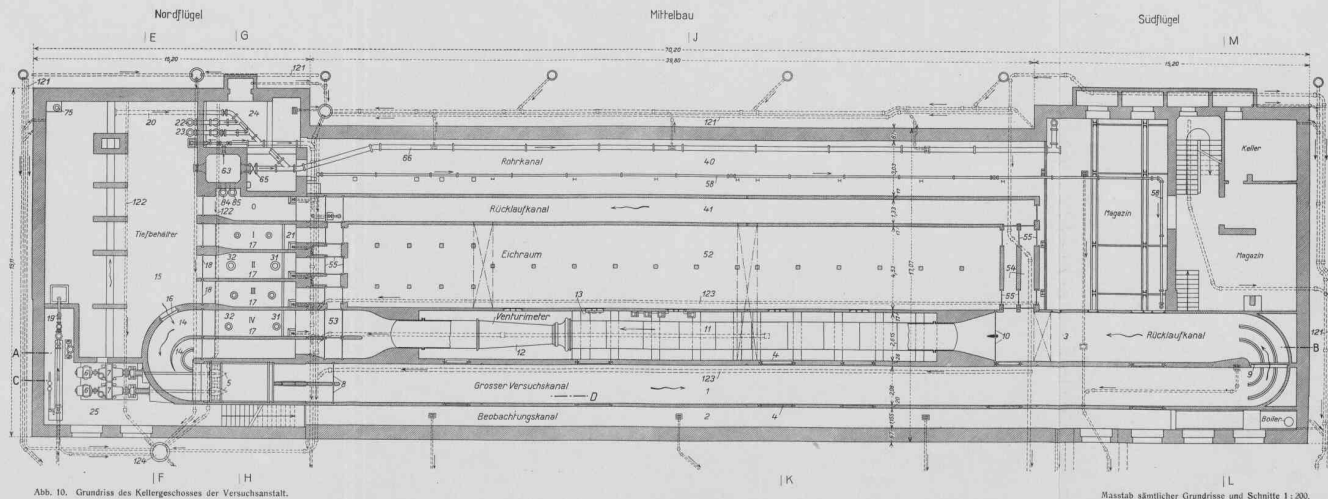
Grundriss des Kellergeschosses der Versuchsanstalt.
